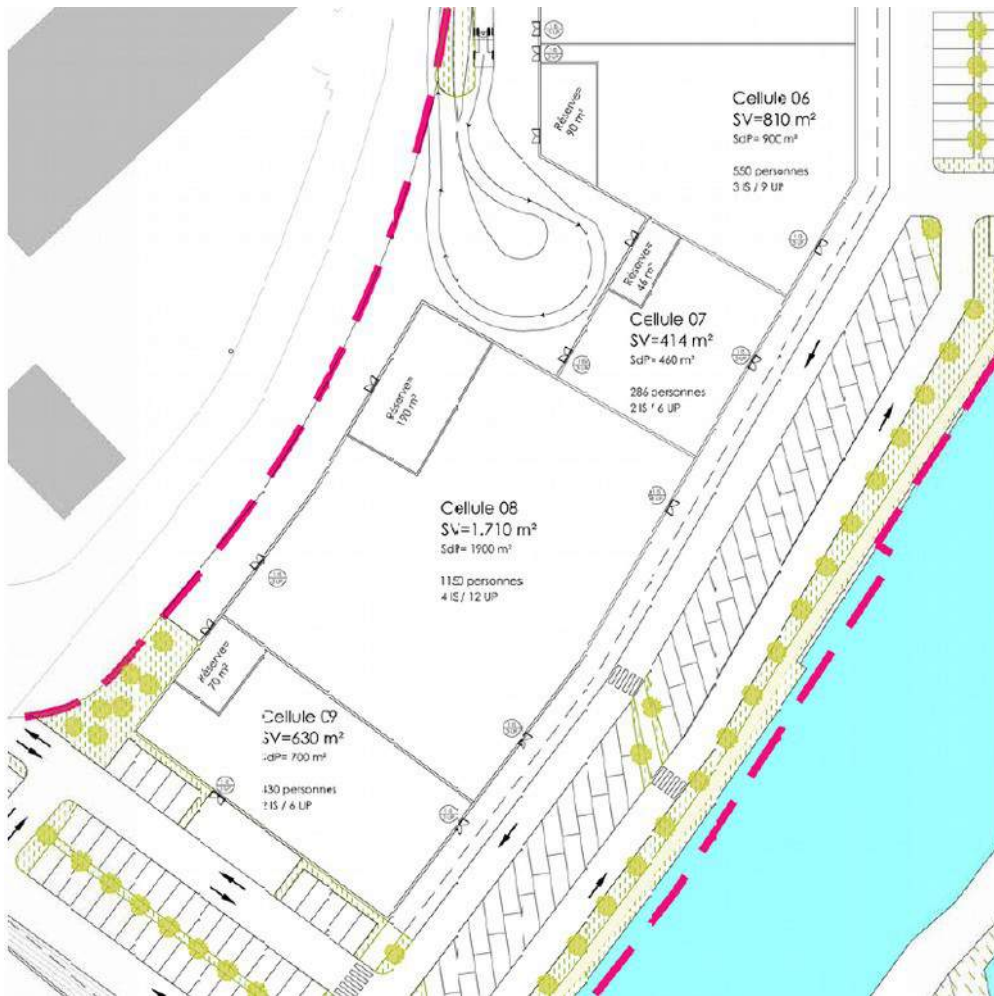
Plan des cellules 6 à 9, échelle 1/500
